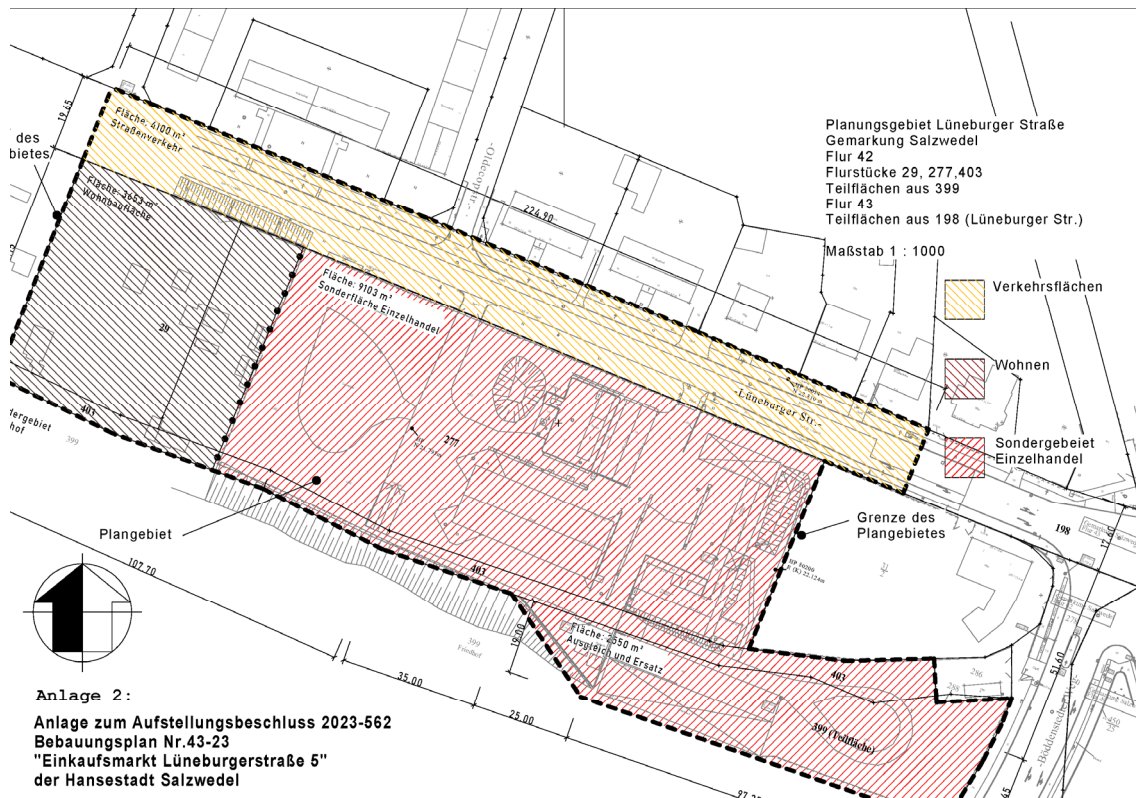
Bebauungsplan Nr. 43-23 "Einkaufsmarkt Lüneburger Straße 5" in Salzwedel
